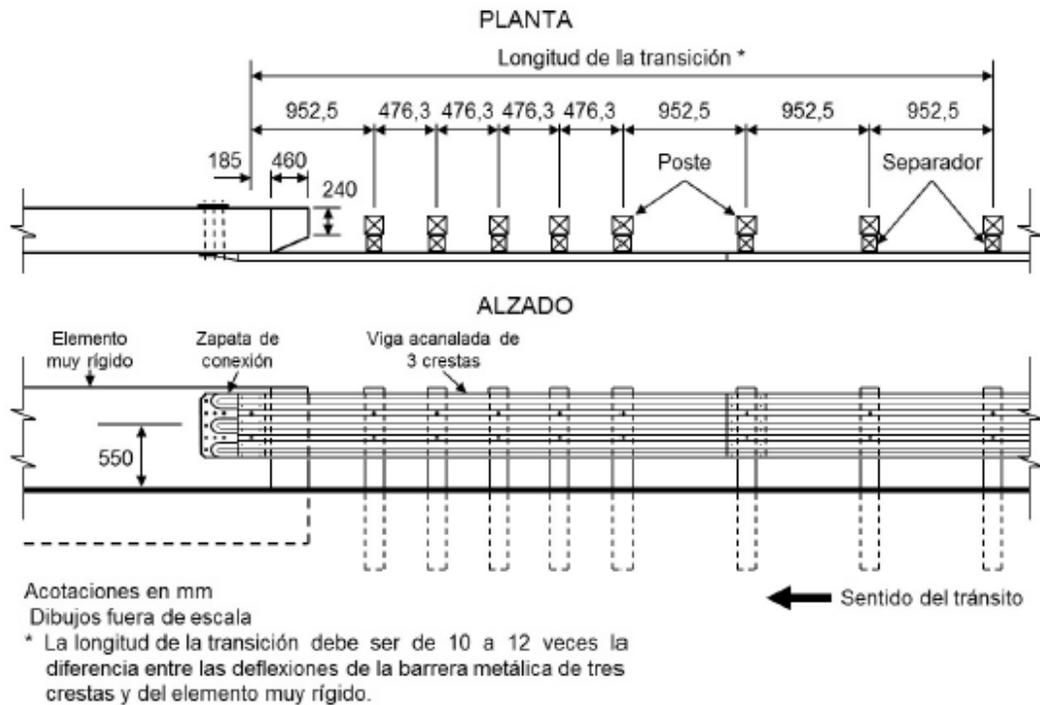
Transición de barrera metálica de tres crestas a muro vertical recto
